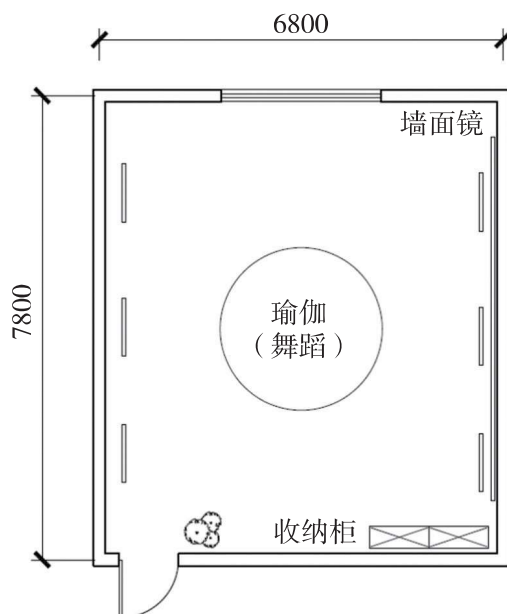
三类小文体活动室平面布局示意 (二) (mm)
